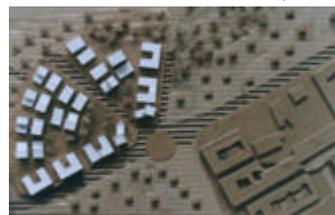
Implantación conjunto de Vivienda de Emergencia en Armenia.
